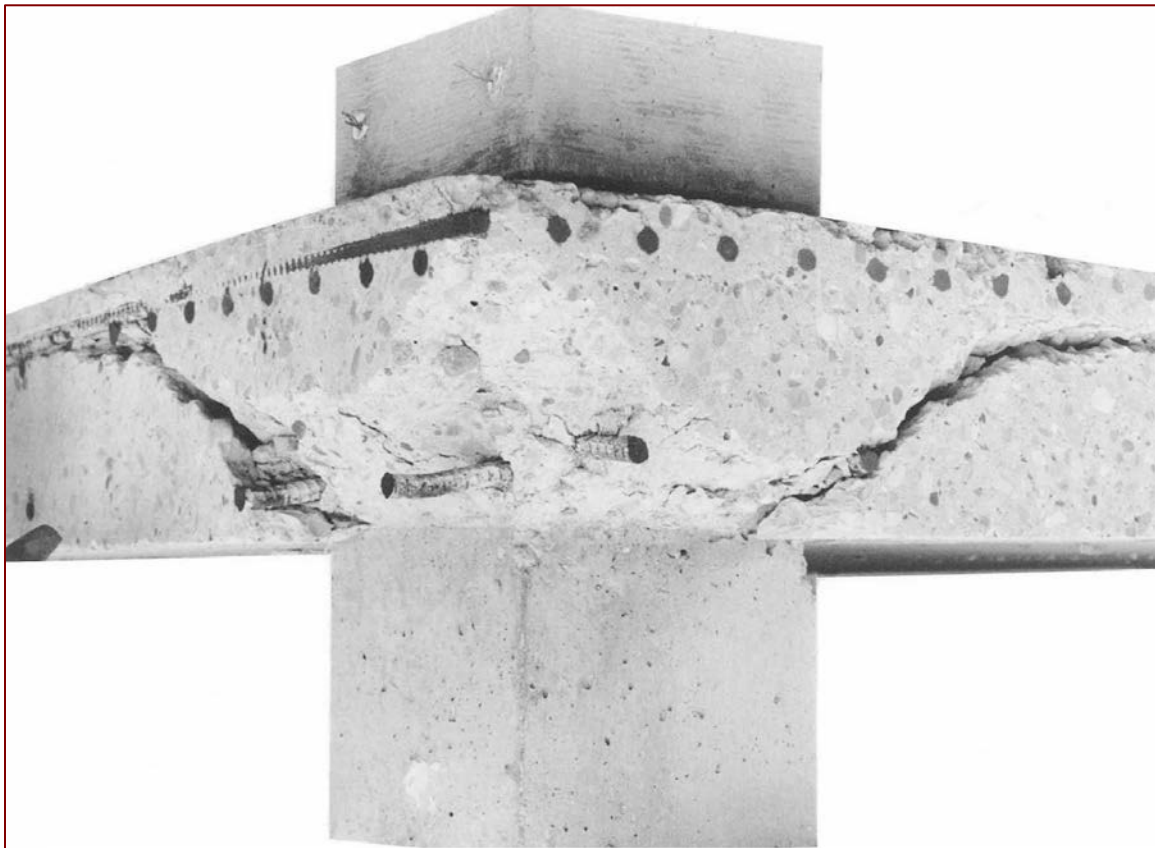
Grietas inclinadas en una losa después de la falla de cortante.
